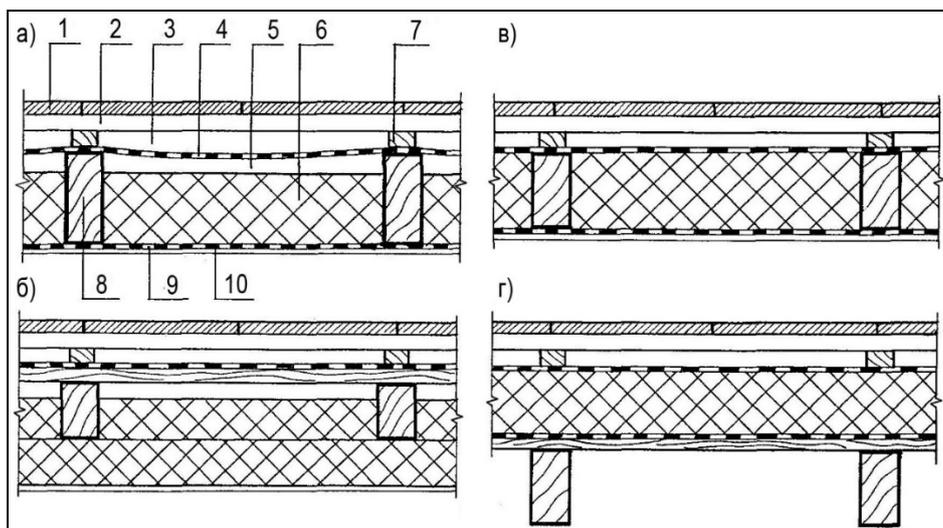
Варианты размещения утеплителя в скатной кровле; 1 – схематично показанный водоизоляционный слой из штучных материалов, 2 – обрешетка, 3 – верхняя вентилируемая воздушная прослойка, 4 – водоизоляционная пленка, 5 – нижняя вентилируемая воздушная прослойка, 6 – утеплитель, 7 – контробрешетка, 8 – стропильная нога, 9 – пароизоляция, 10 – потолочная подшивка
